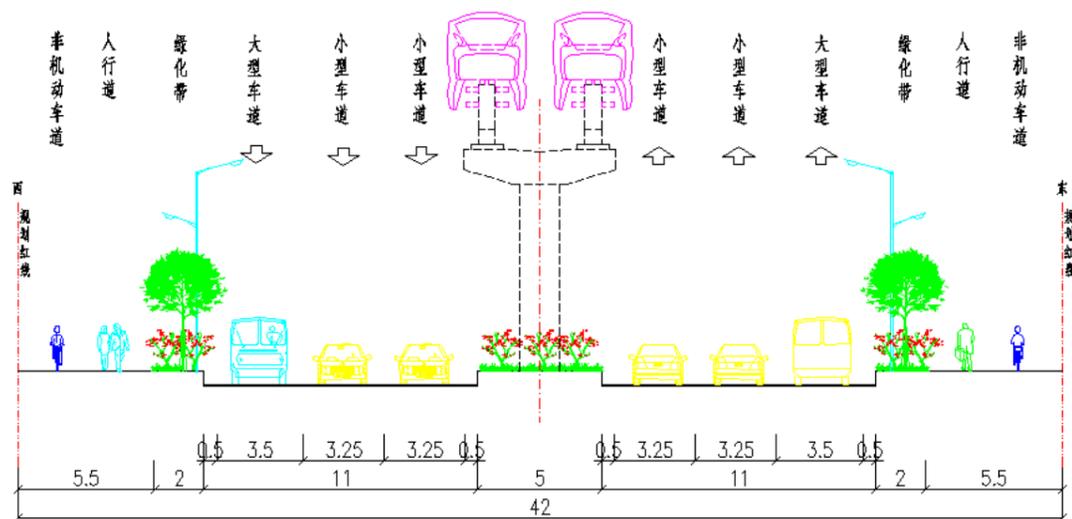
鮀东路、爱民路横断面图（尺寸单位：m）
